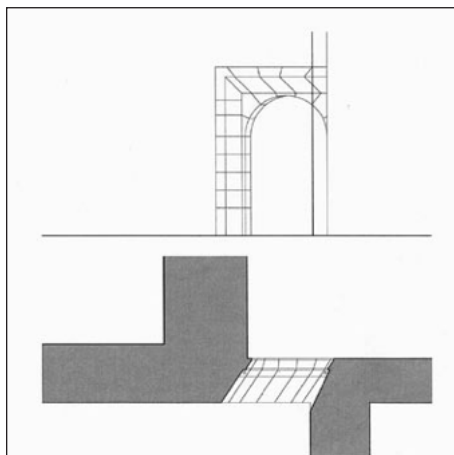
Planta y alzado del hueco en viaje con paso al bis en el P. de La Conquista.
